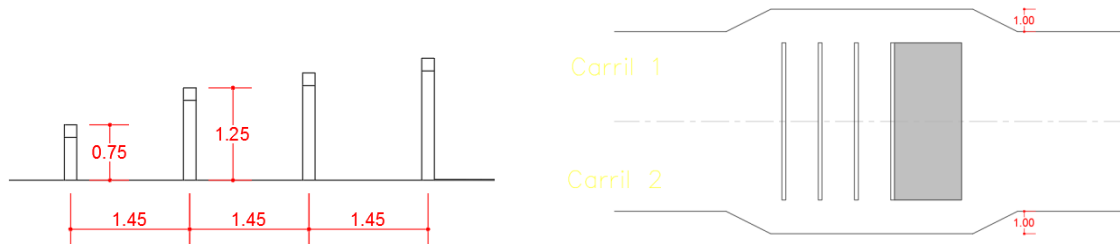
Vista en isométrico y planta del obstáculo de vigas de cuatro pasos
